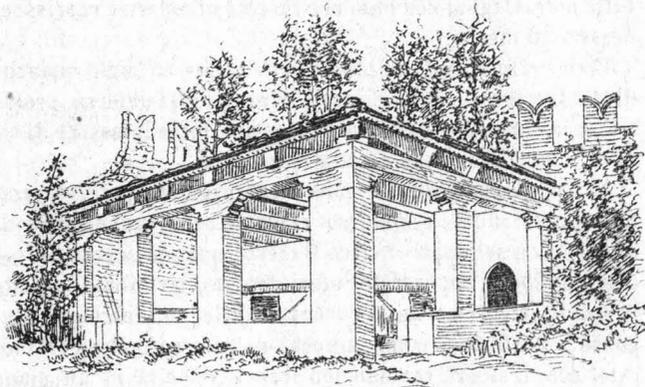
Schizzo prospettico della tettoia delle armi.
